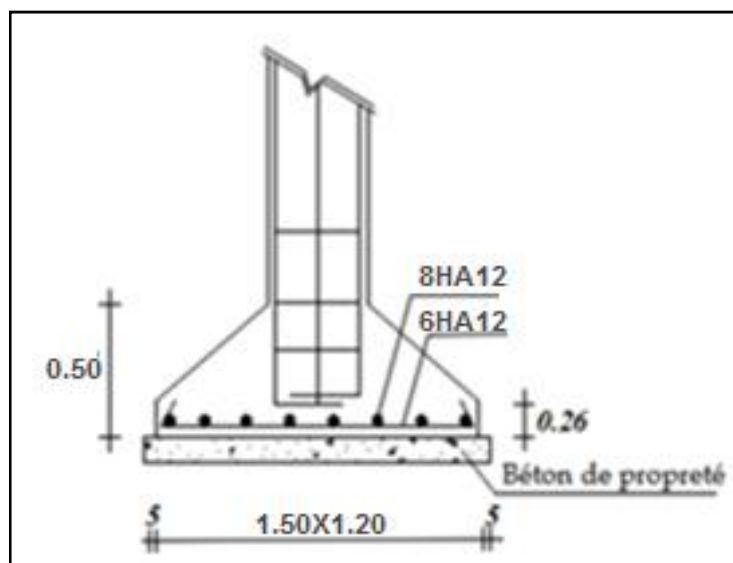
Exemple de ferrailage d'une semelle isolée sous poteau d'angle
